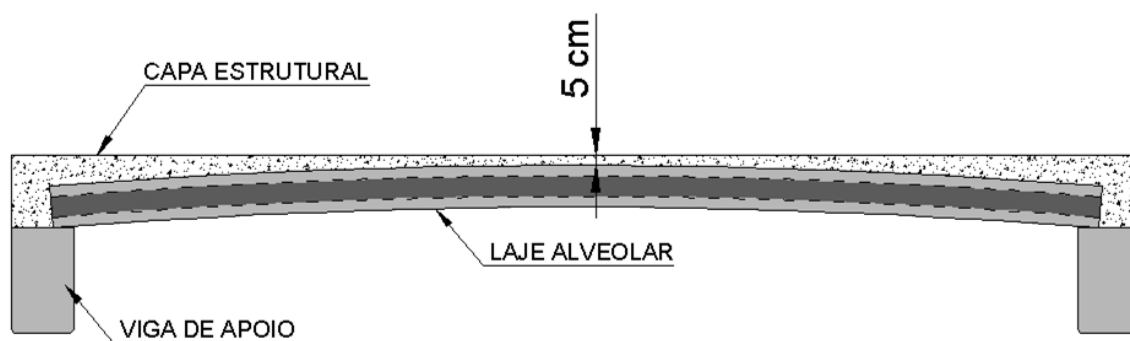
30 – Capa estrutural sobre elemento de laje alveolar com contra-flecha.
